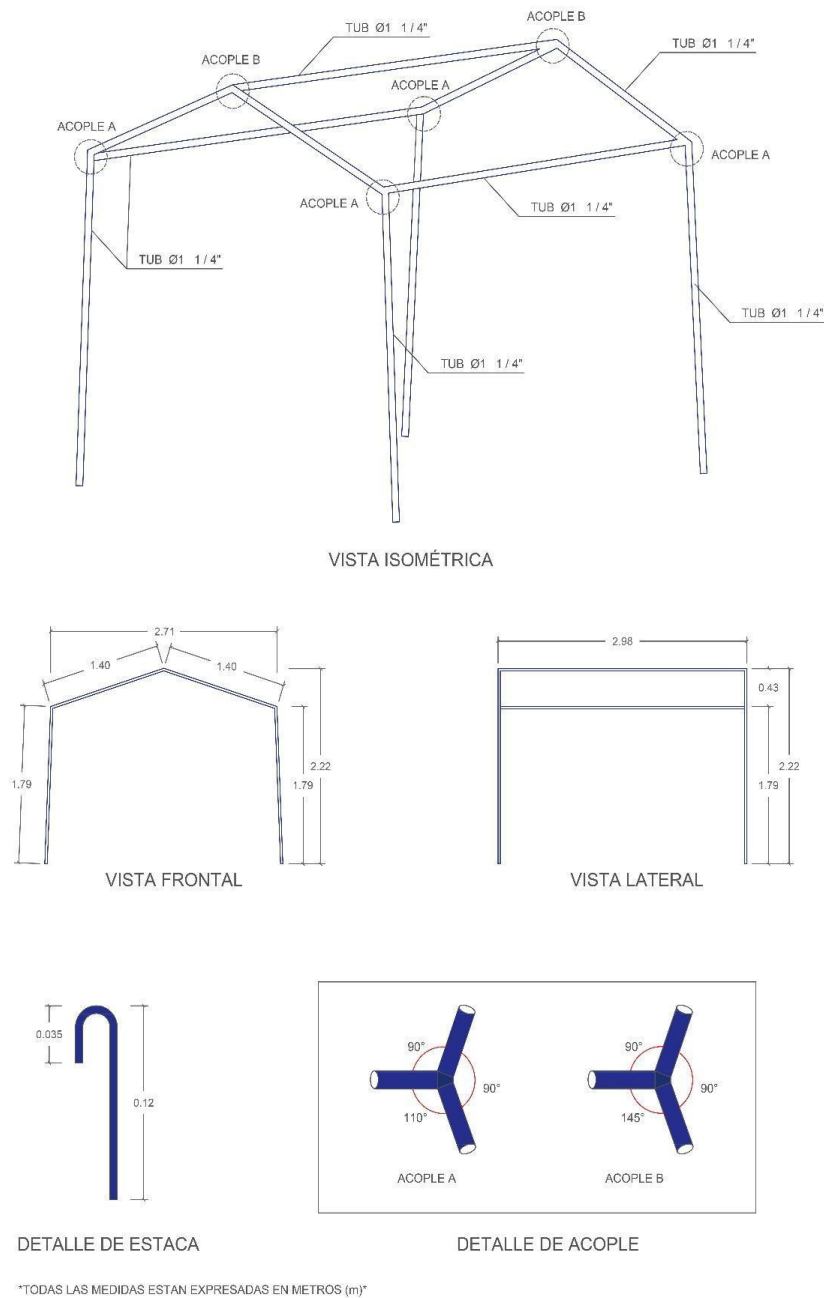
Detalles de estructura de las carpas de emergencia INDECI
